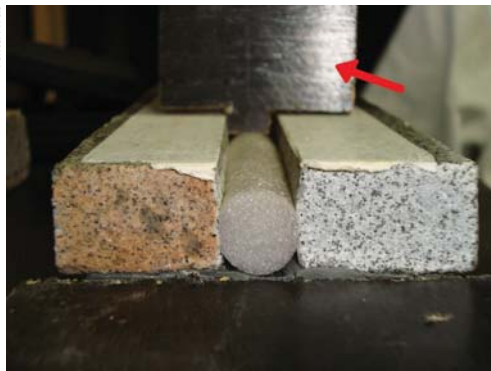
Gabarito para aplicação e posicionamento do corpo de apoio
